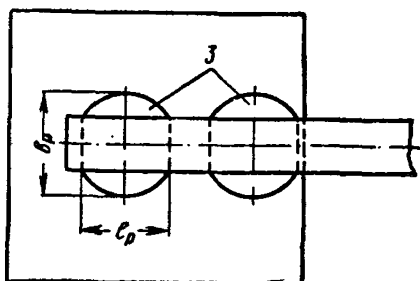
Конструкция нахлесточного соединения элементов закладной детали, выполненного рельефной сваркой
